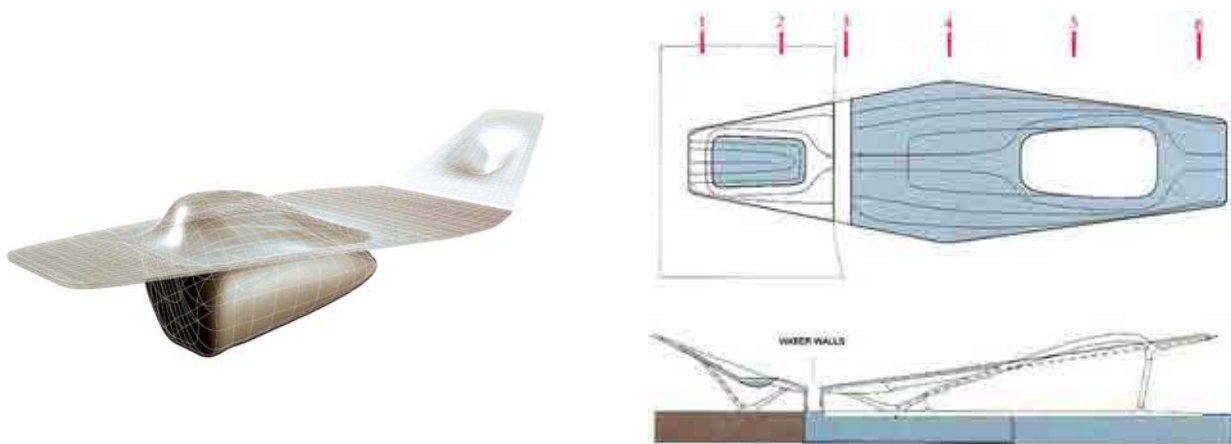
Estudio de la forma a través del modelo digital; planta y alzado de las superficies que revelan la condición líquida del edificio (Pabellón Hydra Pier).
